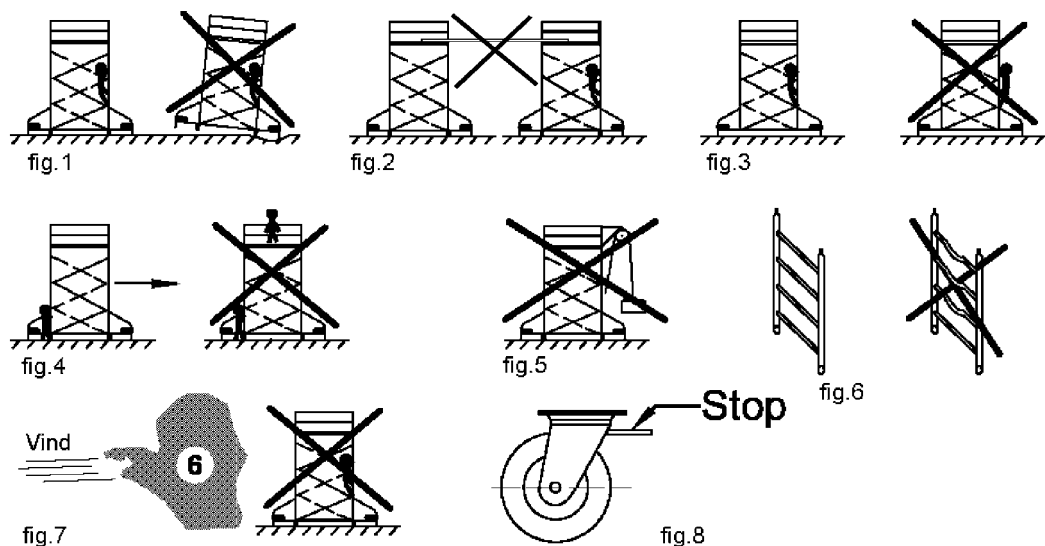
Hopfällbara ställningar och rullställningar får bara placeras på plant, bärkraftigt underlag.
